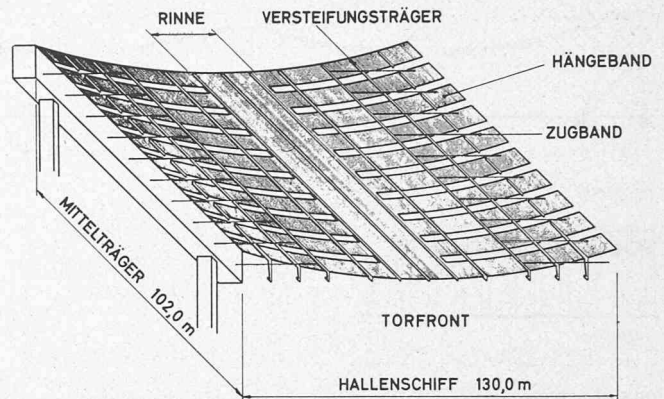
Wartungshalle V, Frankfurt. Konstruktionsschema der Dachfläche eines Hallenschiffs
